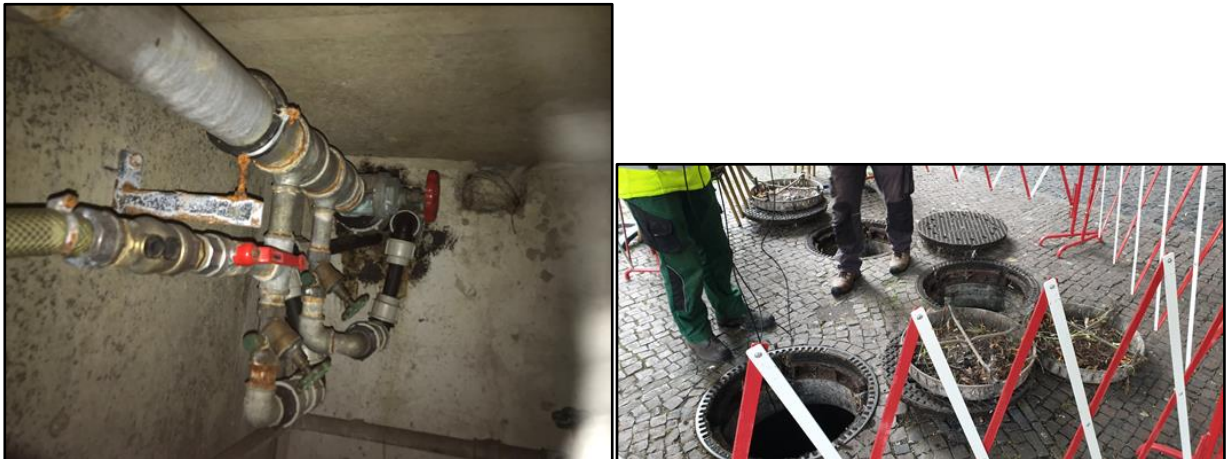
+ 35 Druckrohrleitung zum Brunnen | Installationsschacht
